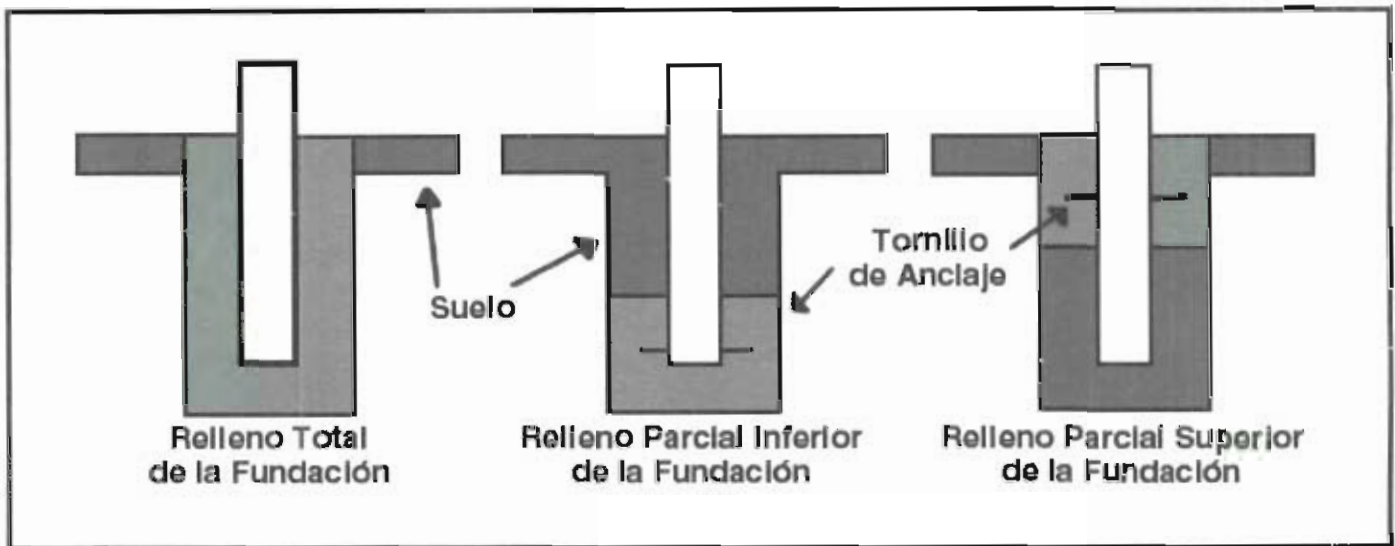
Relleno en Hormigón Para Fundaciones de Postes
